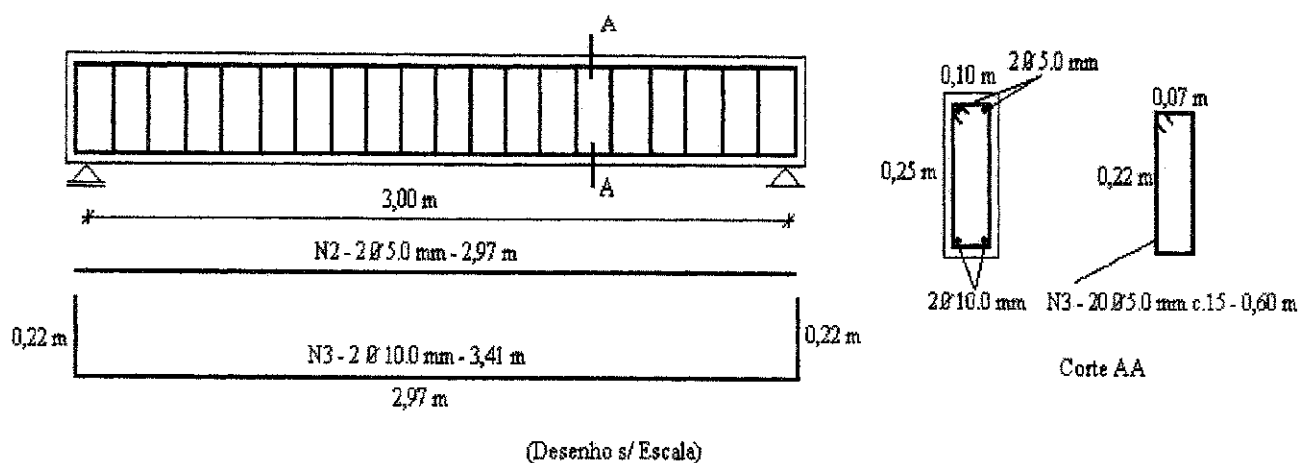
Detalhe das Armaduras das Vigas Ensaaiadas
